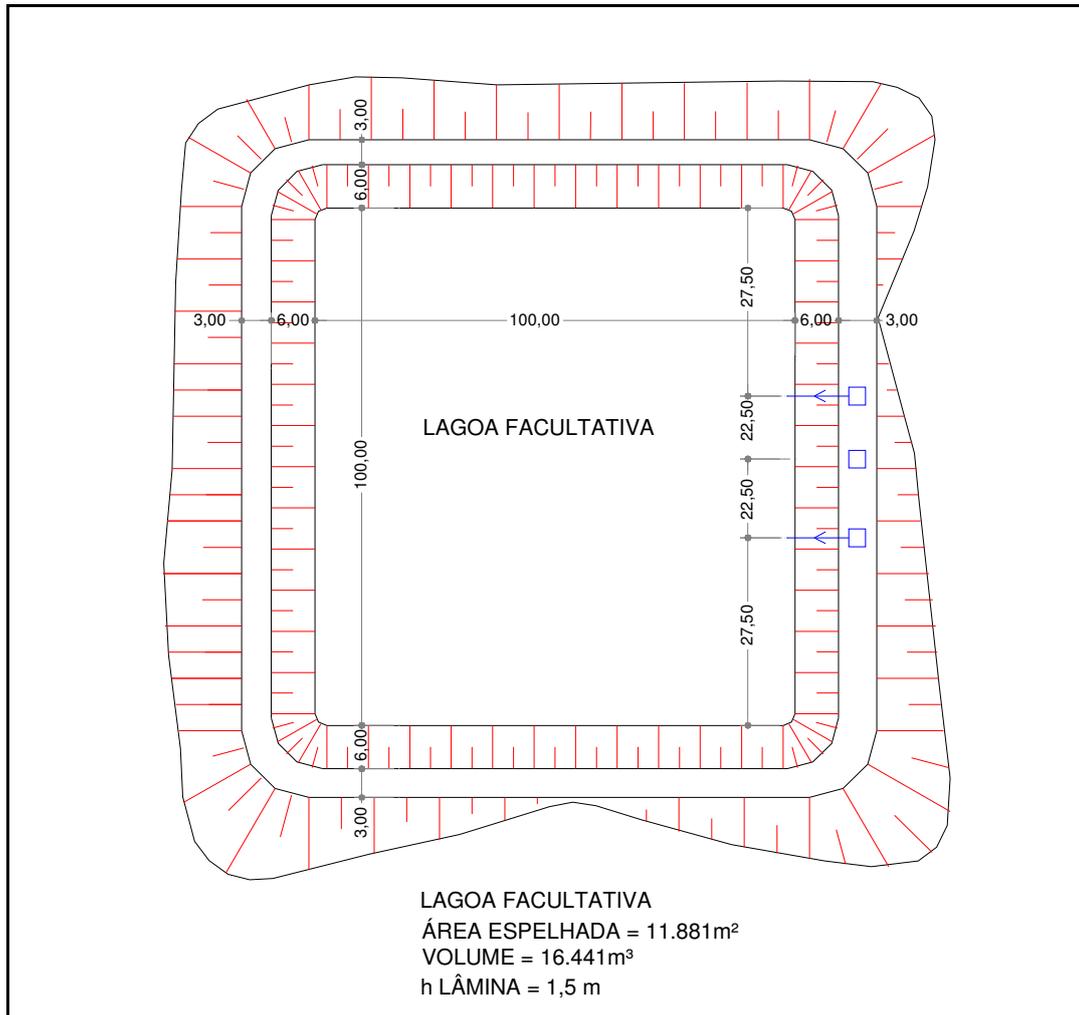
ETE Nosso Teto - Lagoa facultativa
